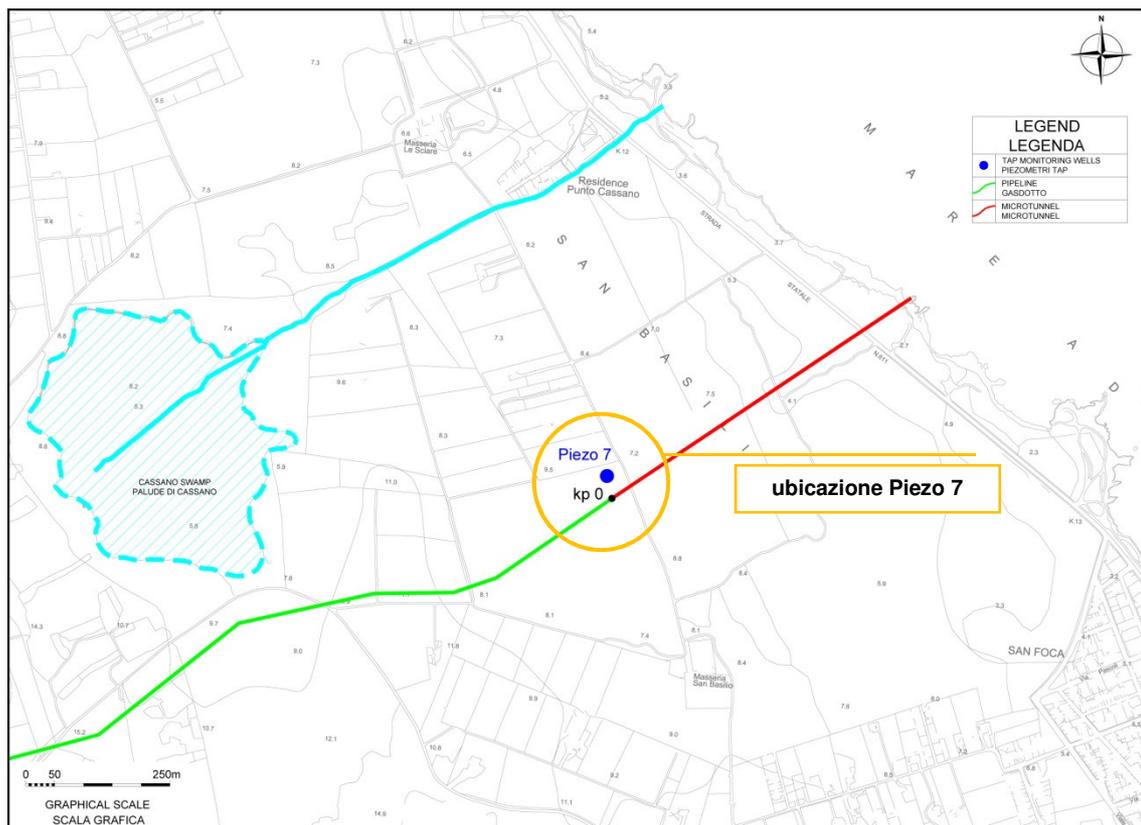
Ubicazione del nuovo piezometro Piezo 7 (attrezzato all’interno del foro del sondaggio NP18)
